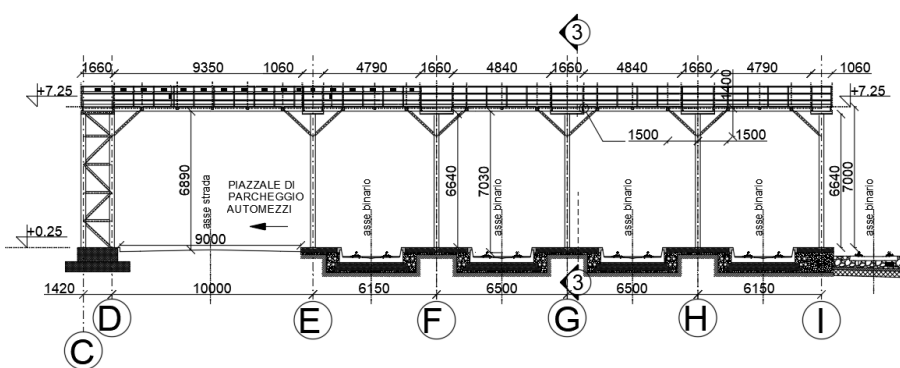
PASSERELLA PEDONALE METALLICA - SEZIONE LONGITUDINALE 1-1
